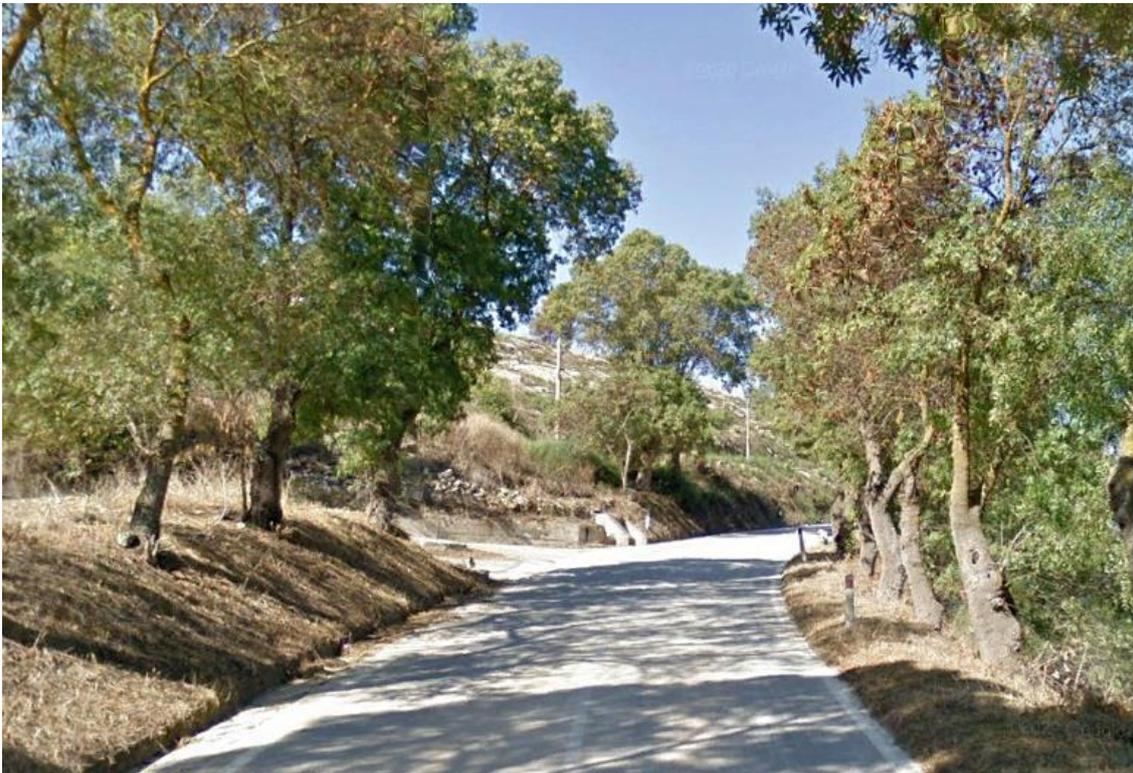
Viabilità locale interessata dal tracciato del cavidotto in corrispondenza dell'attraversamento sul torrente Senora
